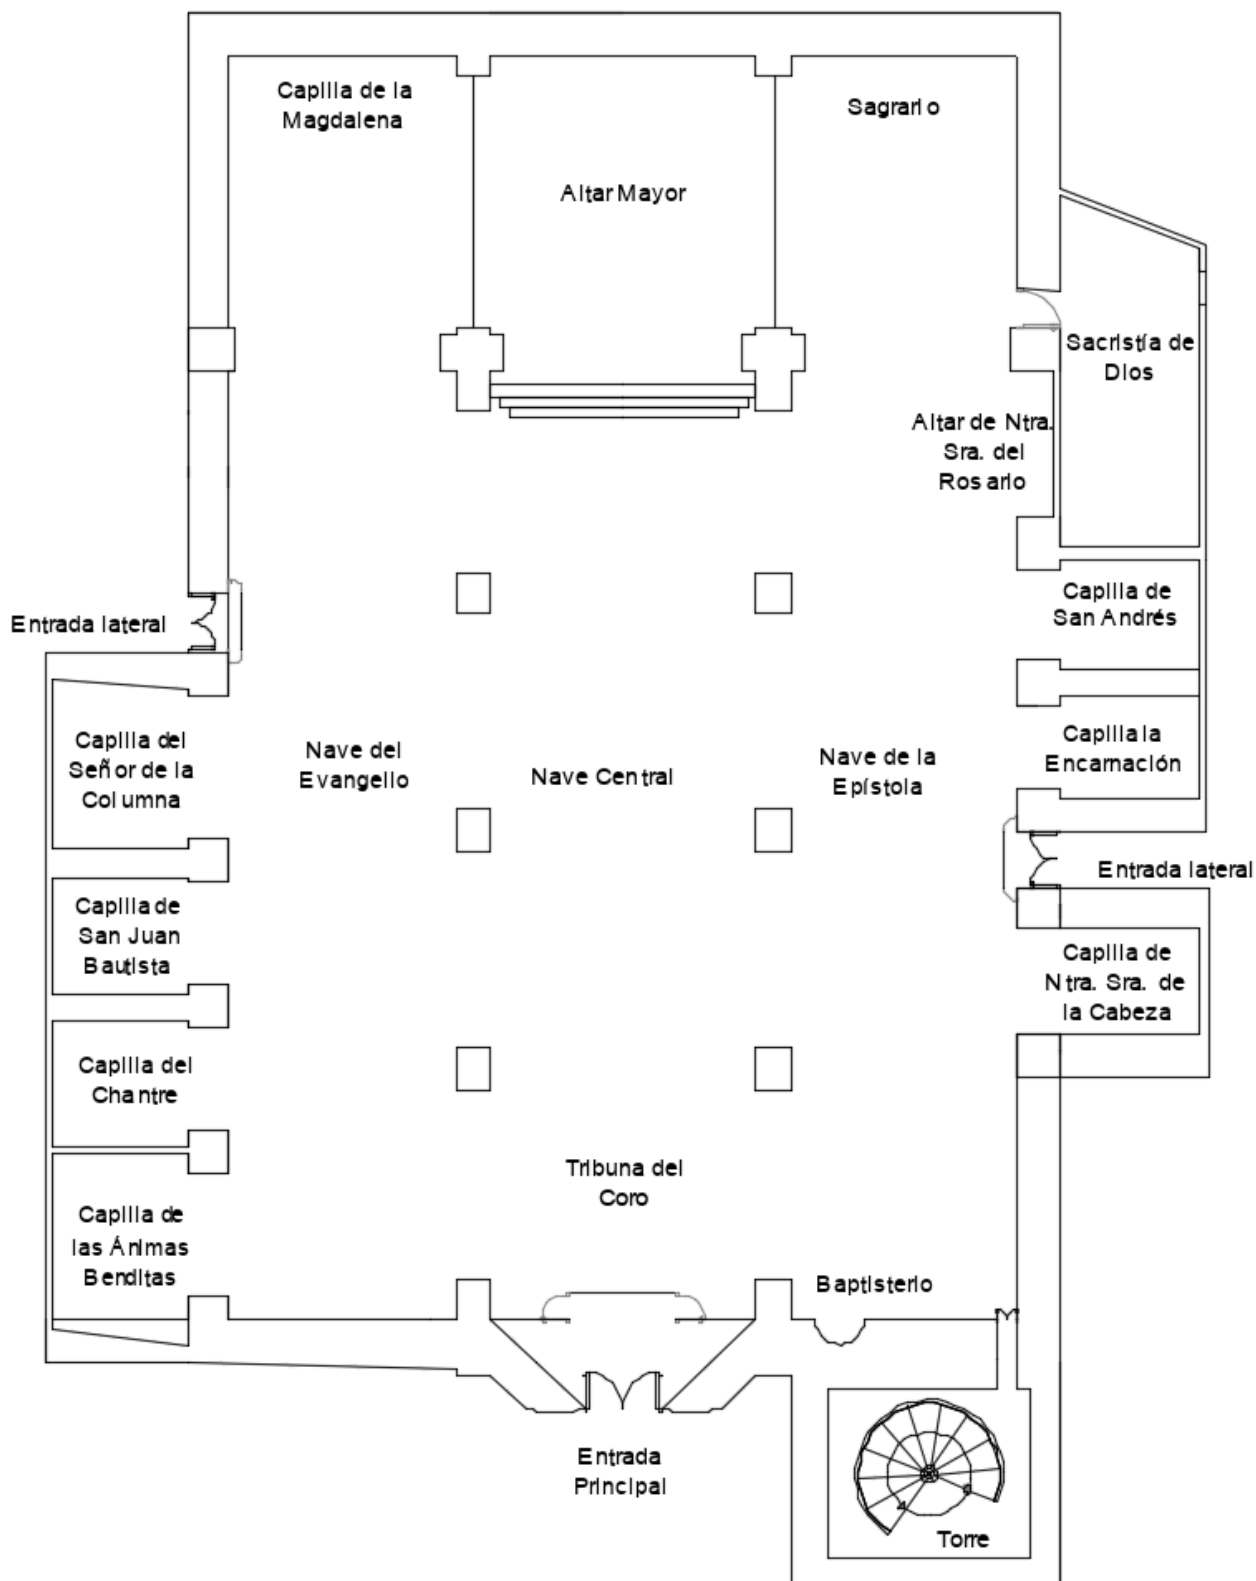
Planta de la iglesia de Santiago en el s. XVI. (Fuente: la autora).
